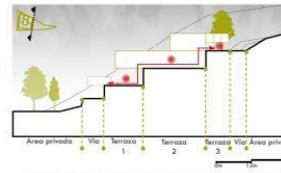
Corte transversal del área construida y no construida. (Autor)
